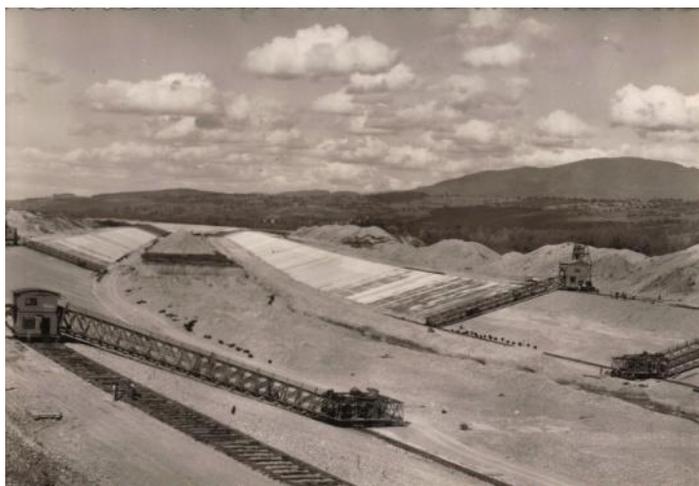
Bétonnage et dallage du canal Source : M. Rioual
